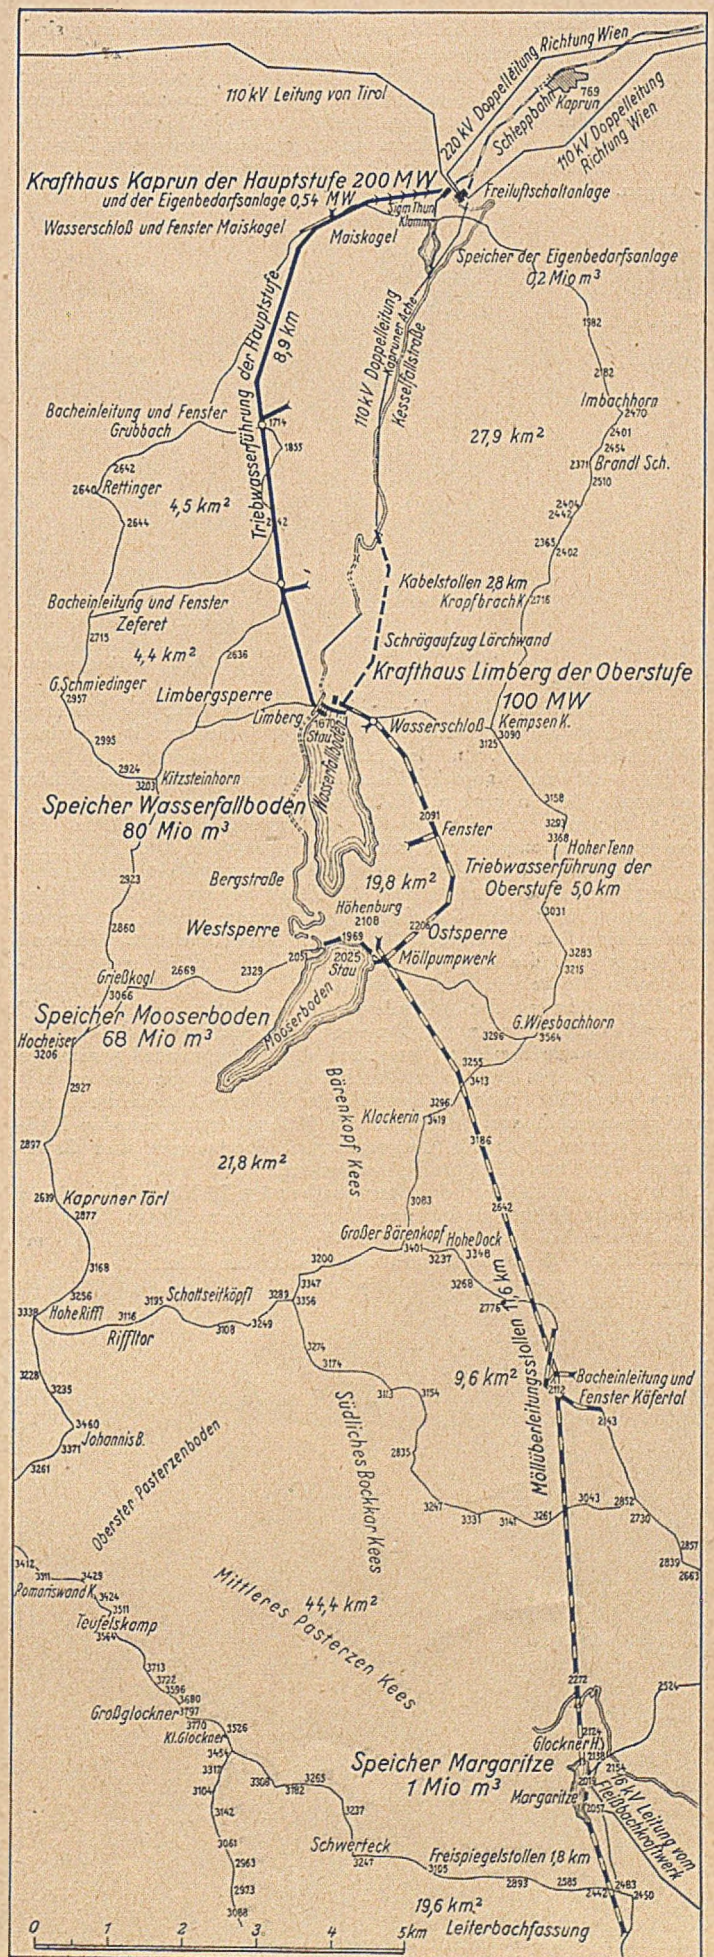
Tauernkraftwerk Glockner-Kaprun. Lageplan.
